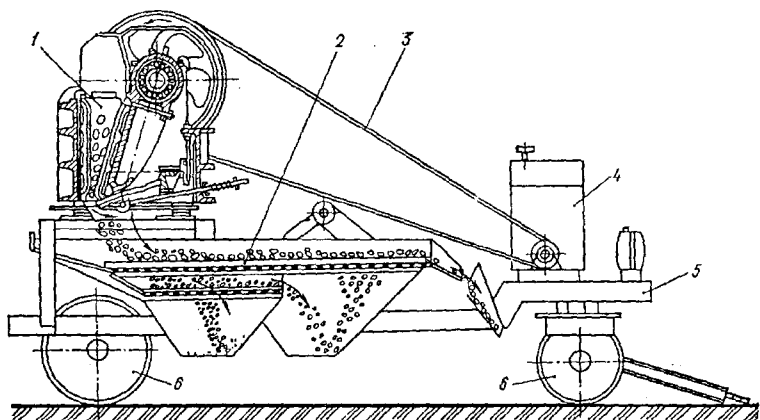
Передвижная дробильно-сортировочная установка малой производительности: 1 – щековая дробилка; 2 – вибрационный грохот; 3 – ремень; 4 – привод; 5 – рама; 6 – тележка.
